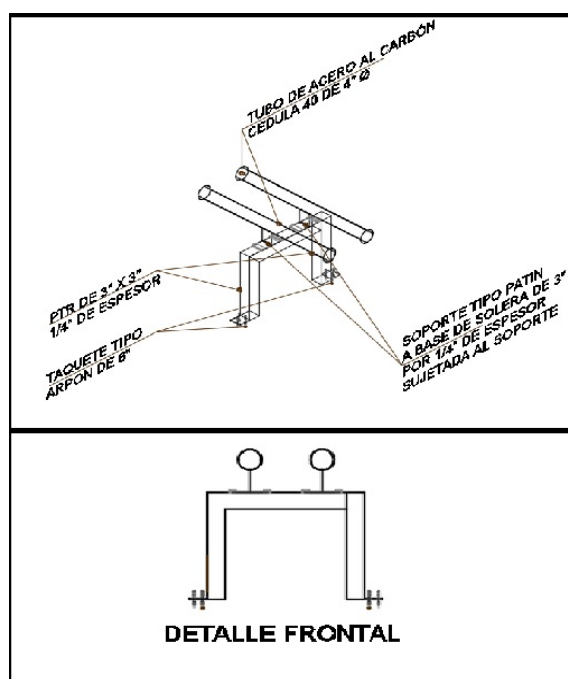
Detalle de Soportería tipo patín Para Tubería
